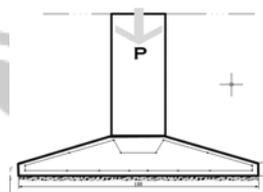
Pondasi Menerus (*Continuous Footing*)
